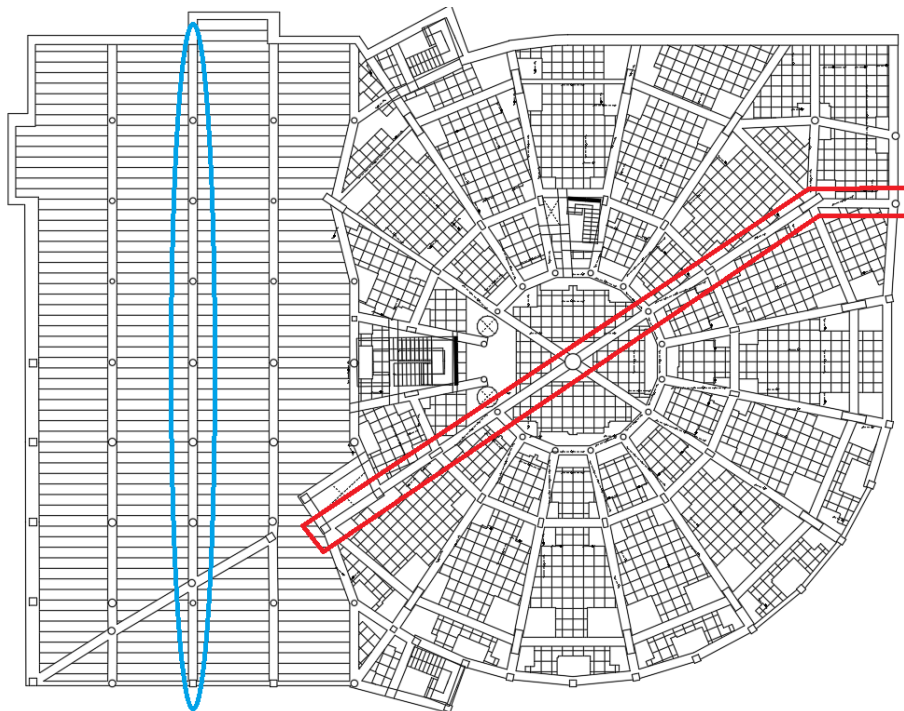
Situación de pórticos 8 y 17 en planta baja del edificio.
